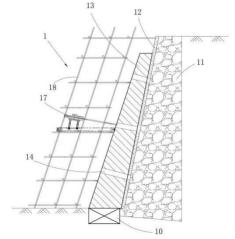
为利用锚杆钻机通过钢筋混凝土面板及钢筋混凝土
